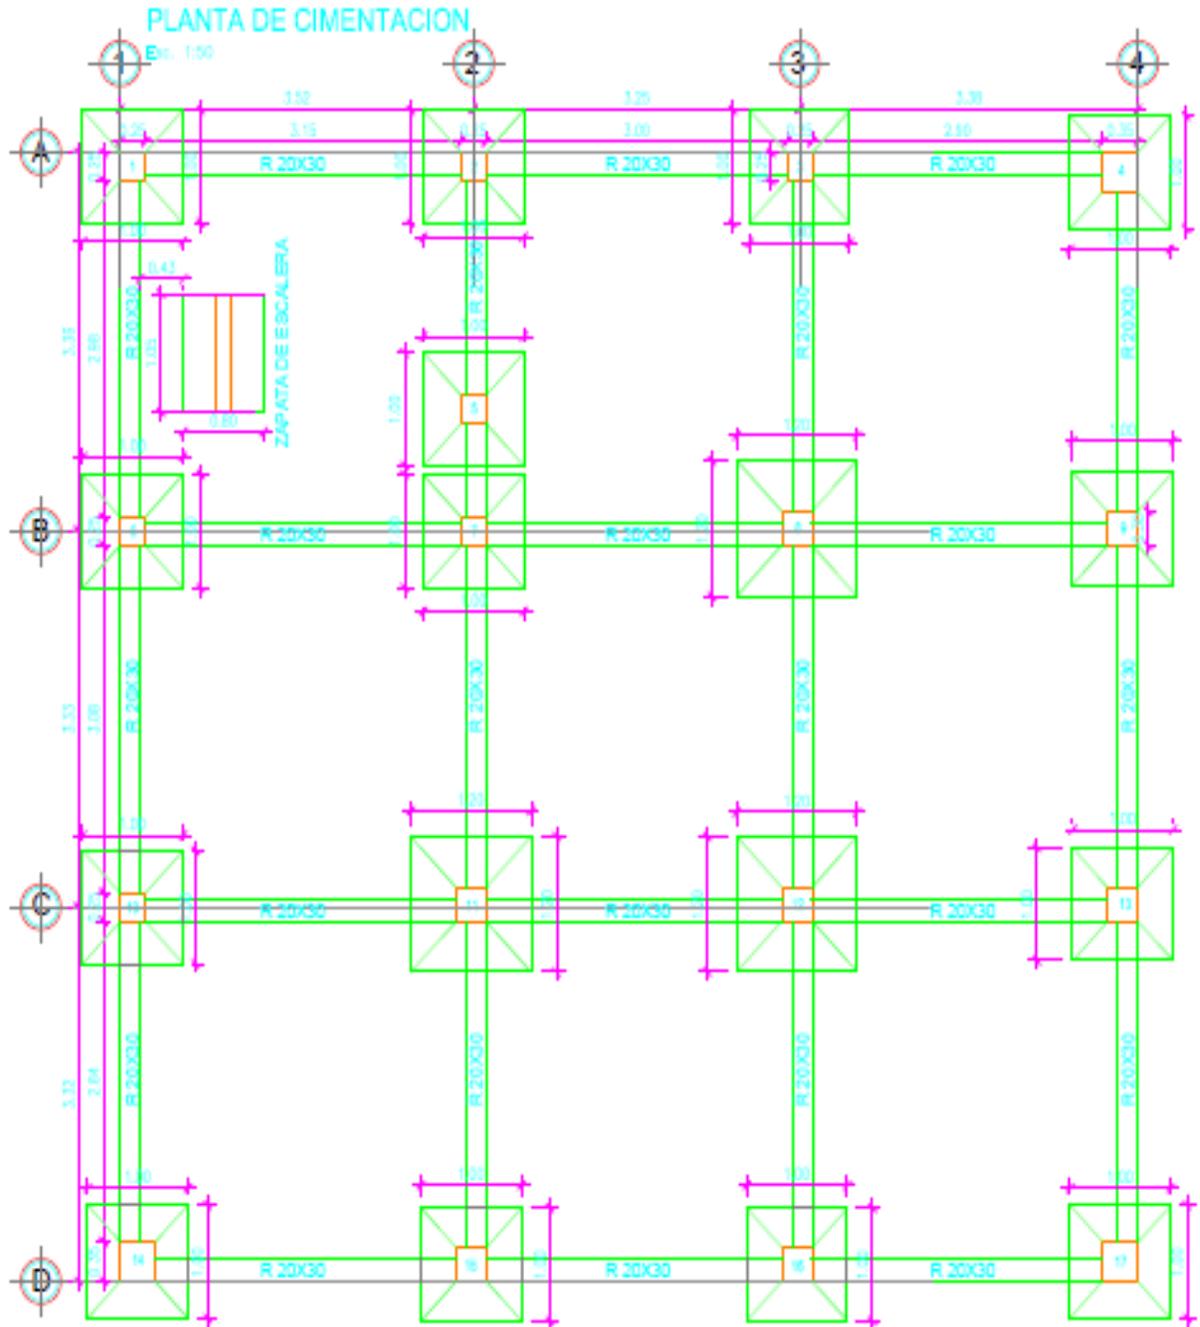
; Plano de cimentación del diseño de hormigón armado vista en planta.
